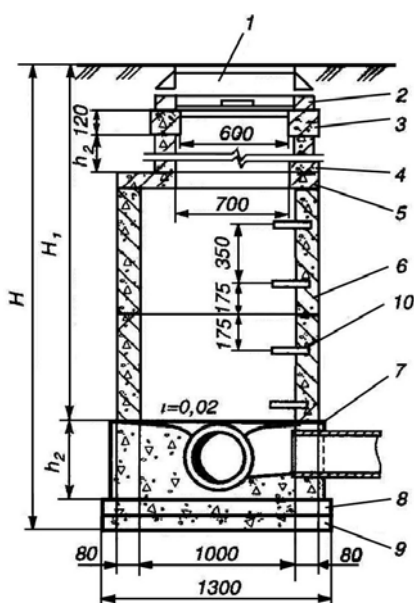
Типовой колодец из стандартных железобетонных колец диаметром 150 – 600 мм:
